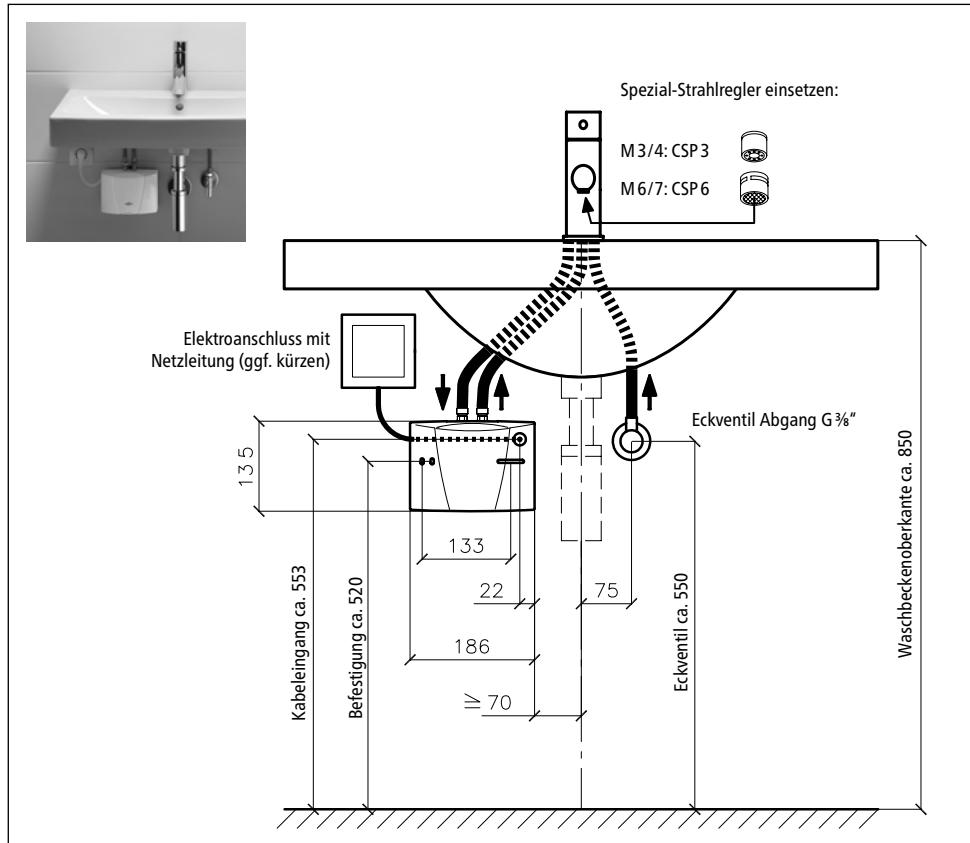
»Drucklose (offene) Installation mit Armatur für drucklose Warmwassergeräte« (Maßangaben in mm)
